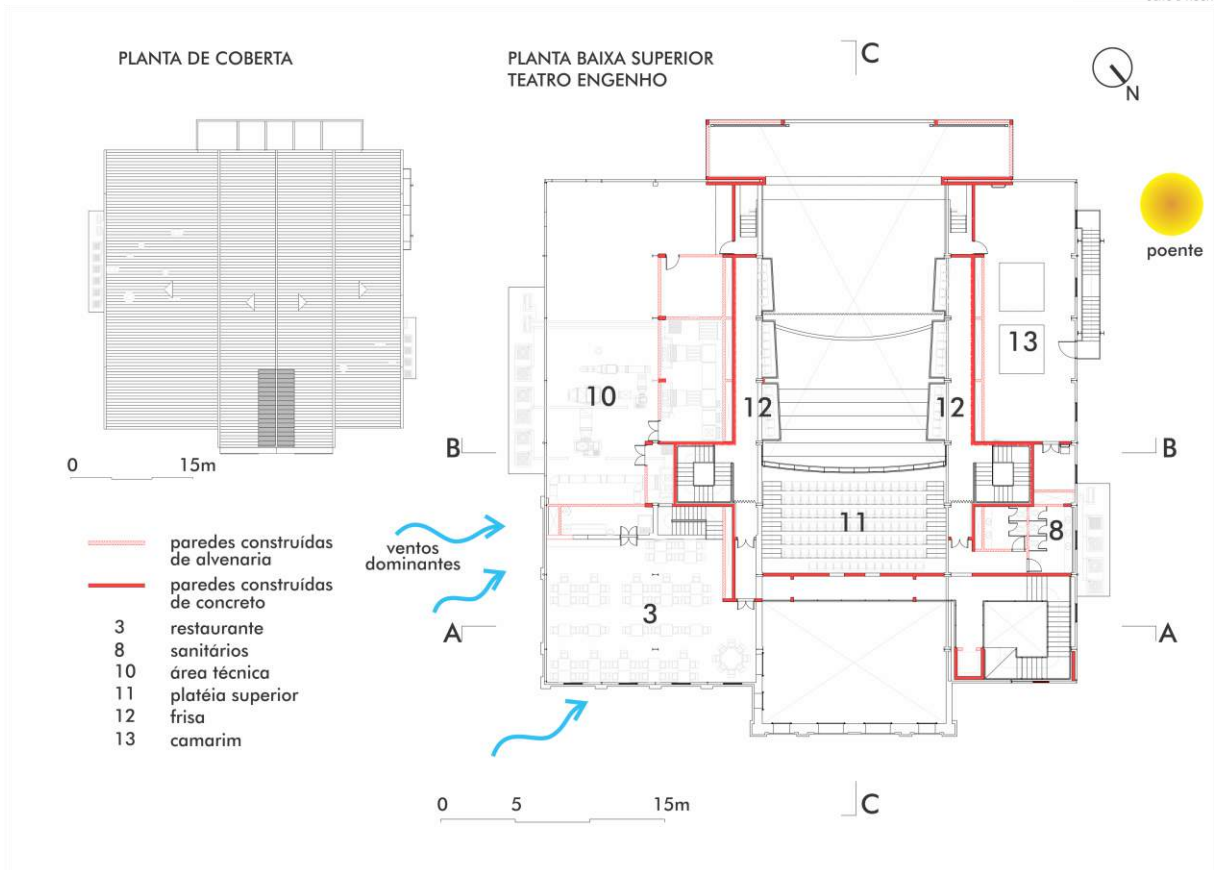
Planta baixa andar superior e cortes Teatro Engenho.
